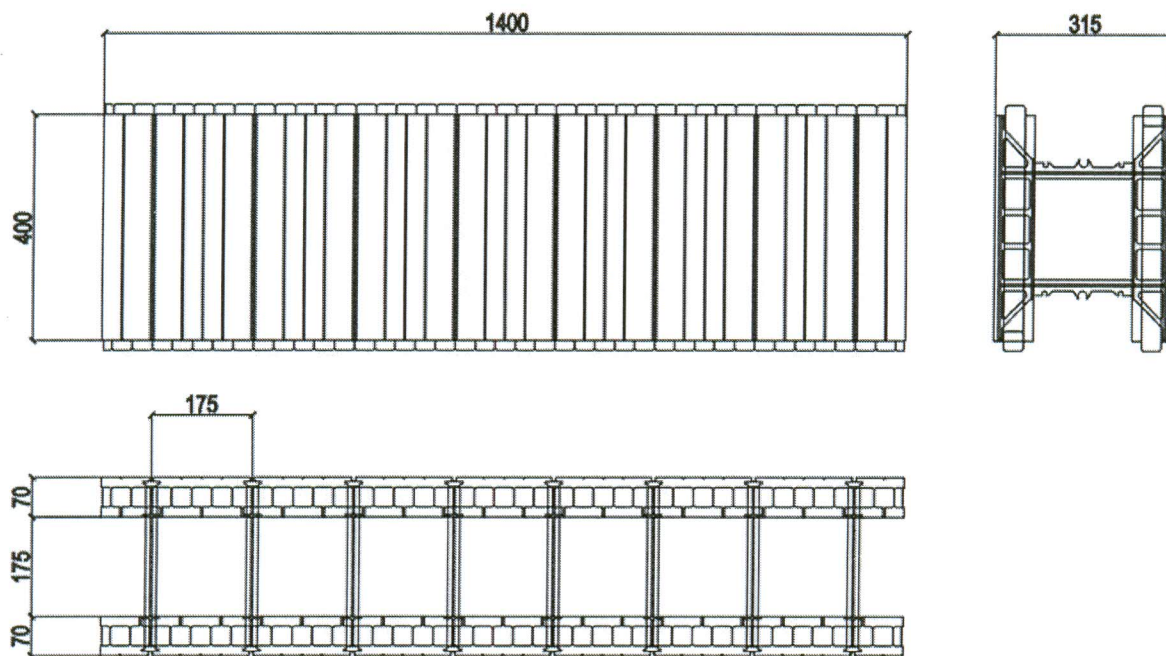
Блок несъемной пенополистирольной опалубки “ТСТ-ДОМ”.
